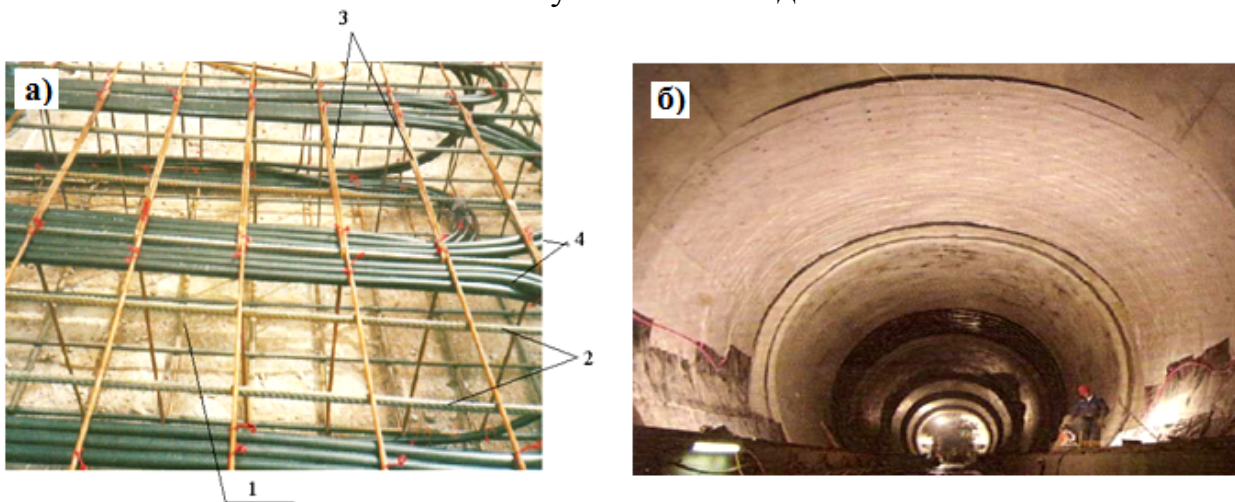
Варіанти розміщення колекторів ґрунтових насосів в елементах будівель і споруд: а – плитний фундамент; б – тунель; 1 – просторовий арматурний каркас; 2, 3 – поздовжня і поперечна арматура; 4 – пластикові труби колектора теплового насоса
